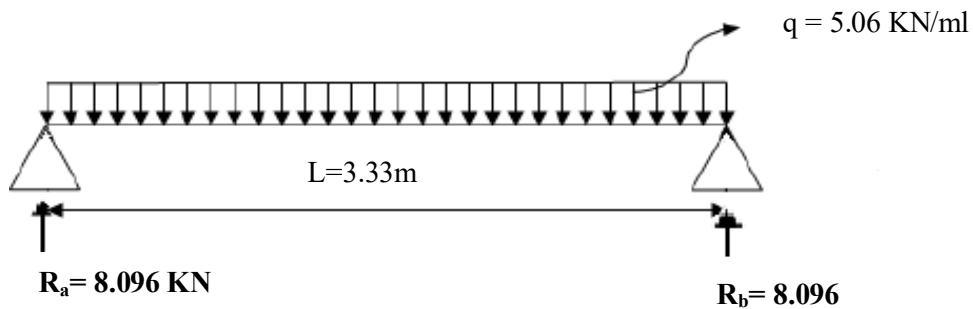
schéma statique de la poutre de chaînage a L’ELU.
